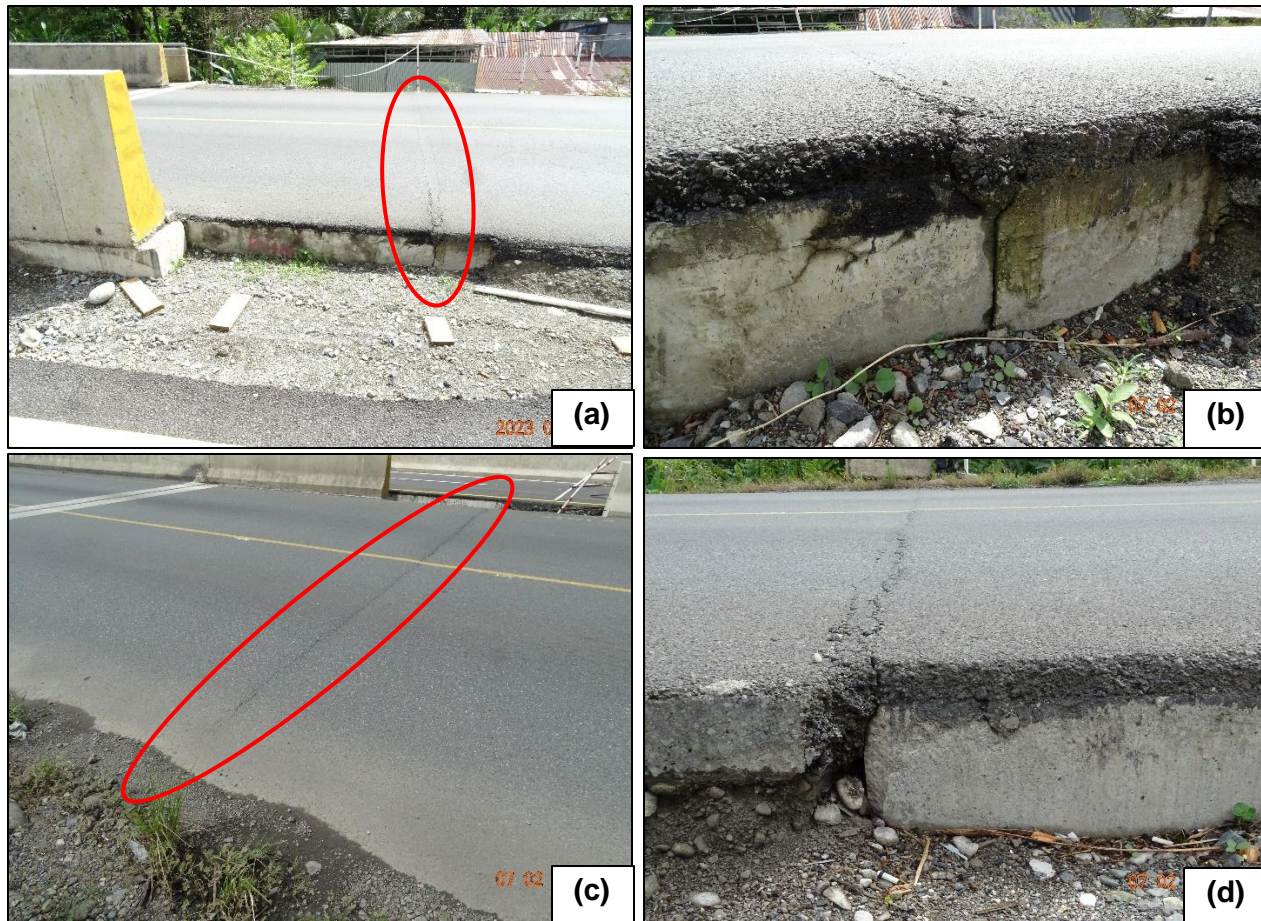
Agrietamiento de la carpeta asfáltica a lo largo del borde de la losa de aproximación del puente nuevo sobre el río San Miguel. (a) Vista general Acceso 1. (b) Vista lateral Acceso 1. (c) Vista general Acceso 2. (d) Vista lateral Acceso 2.
